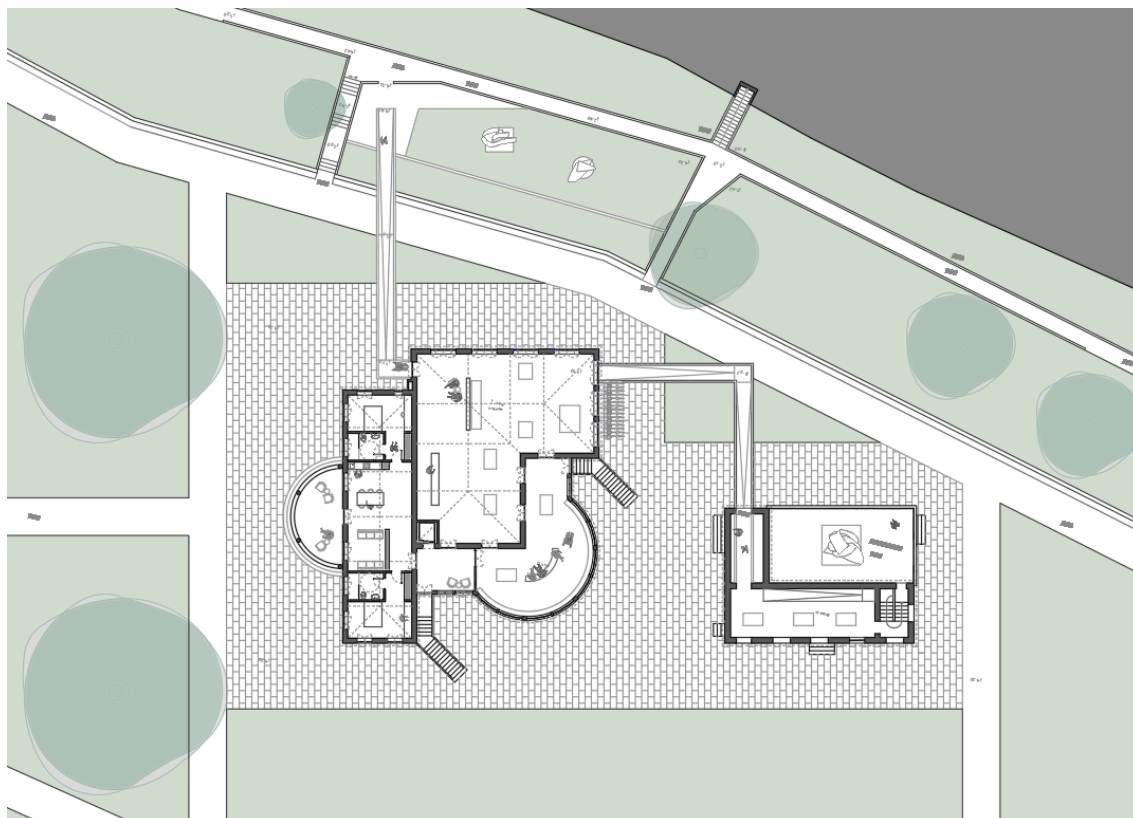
EAG - planta Piso 1, desenho 48 (elaborado pelo autor)
